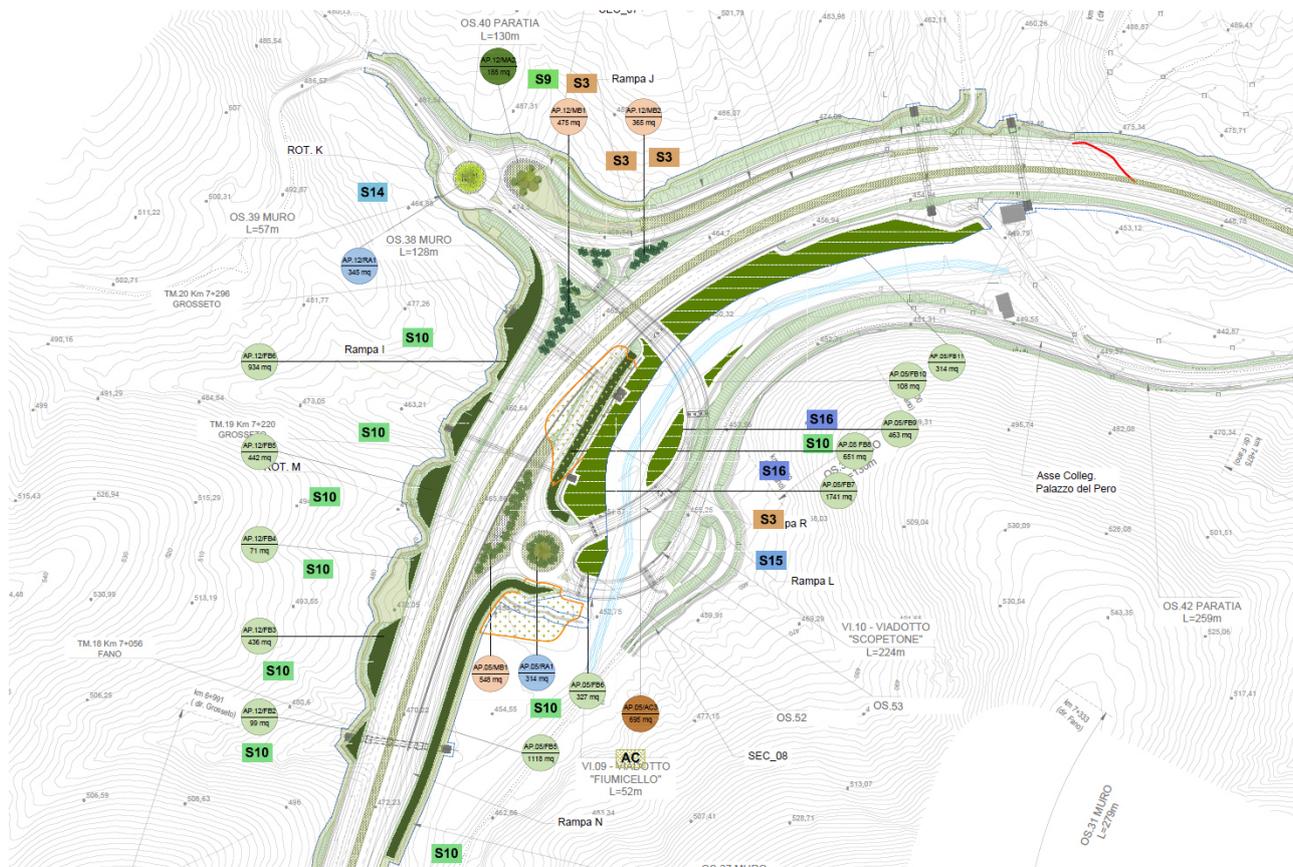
Stralcio della planimetria delle opere a verde, svincolo “Scopetone”
